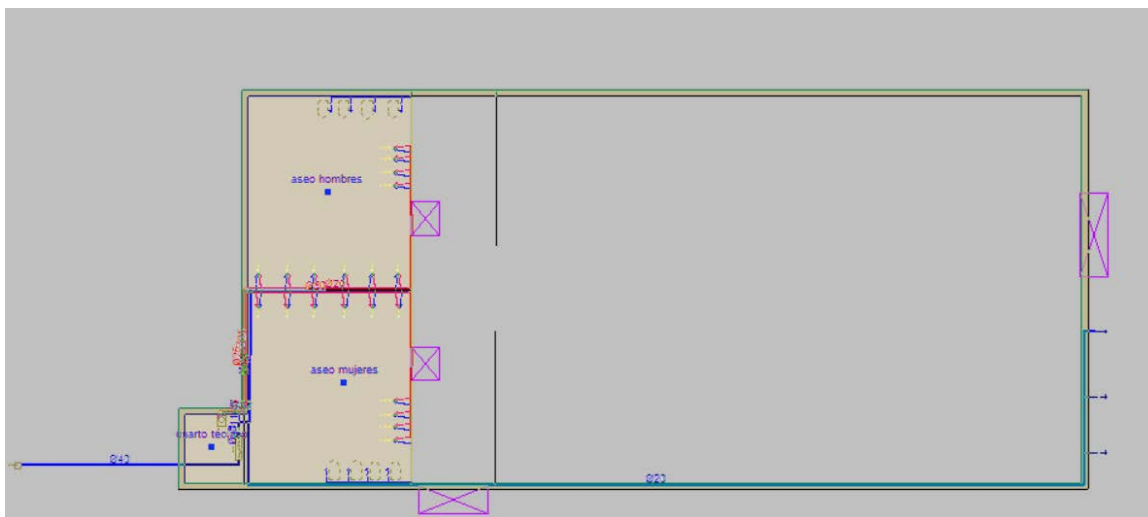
Vista en planta de la red de abastecimiento. Fuente: CYPECAD MEP
